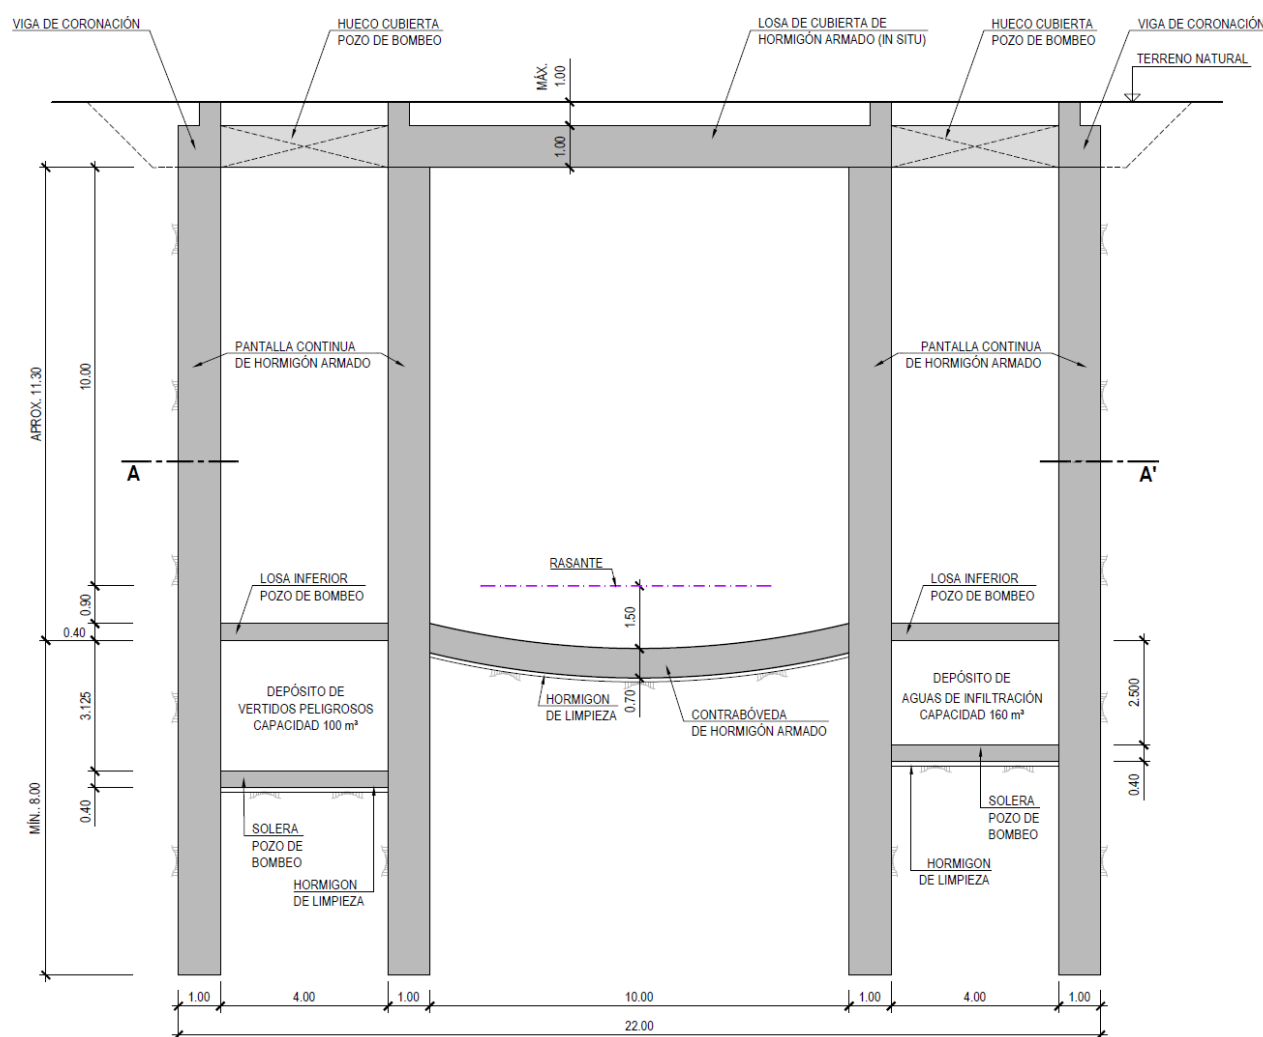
a. Sección estructural con pantallas continuas en pozos de bombeo ubicados en el punto bajo del tramo soterrado (P.K. 202+330).
